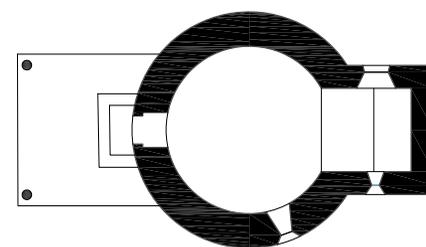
Grundriss St. Georgen/Lavanttal, M 1:200. CA 2014.
